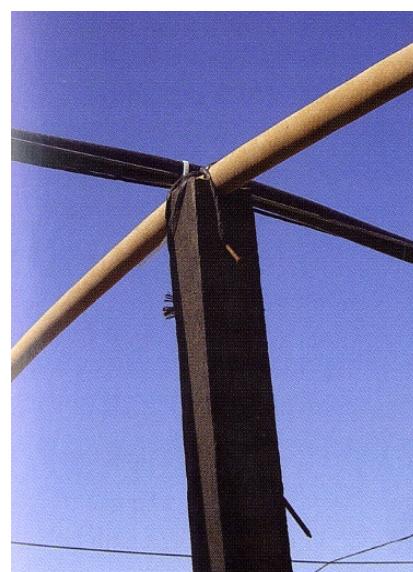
Detalle del pilar interior, con una hendidura para que encaje perfectamente el arco
